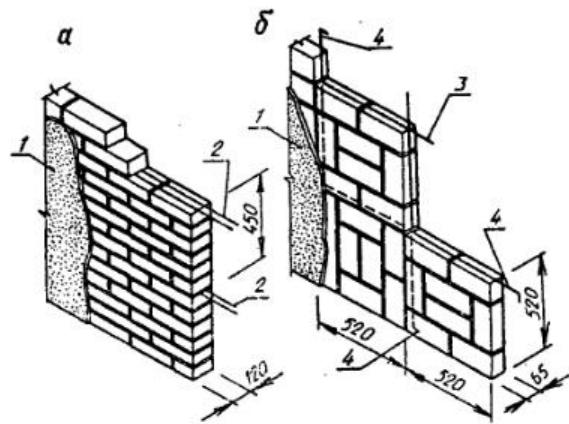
Кирпичные перегородки: а — кирпичная в 1/2 кирпича армированная; б — то же в 1/4 кирпича. 1 — отделочный слой; 2 — горизонтальная арматура; 3 — то же, вертикальная и горизонтальная; 4 — отгибы арматуры для крепления к стенам и перекрытию.
